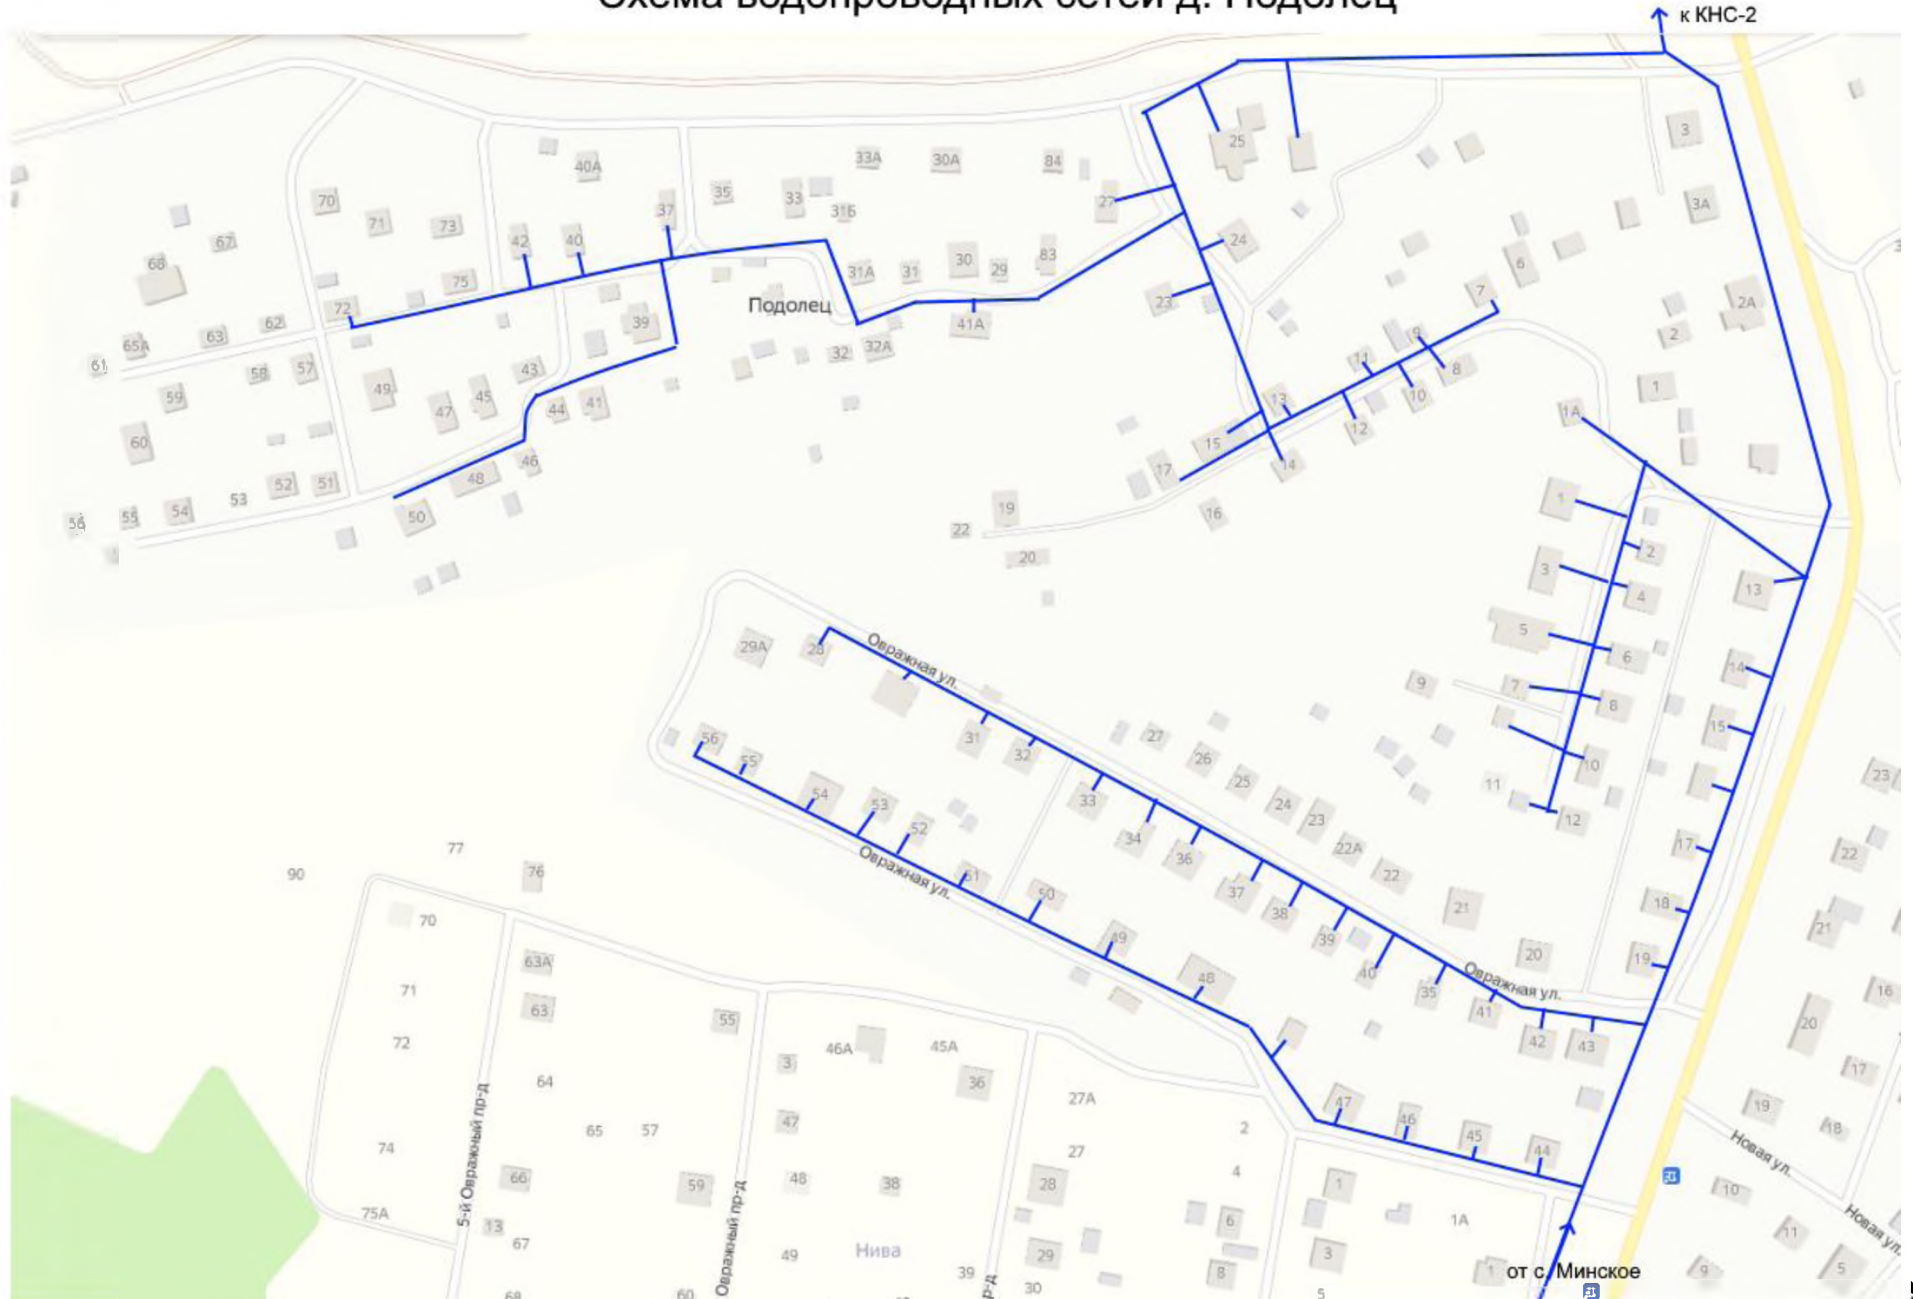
Схема водопроводных сетей д. Подолец
